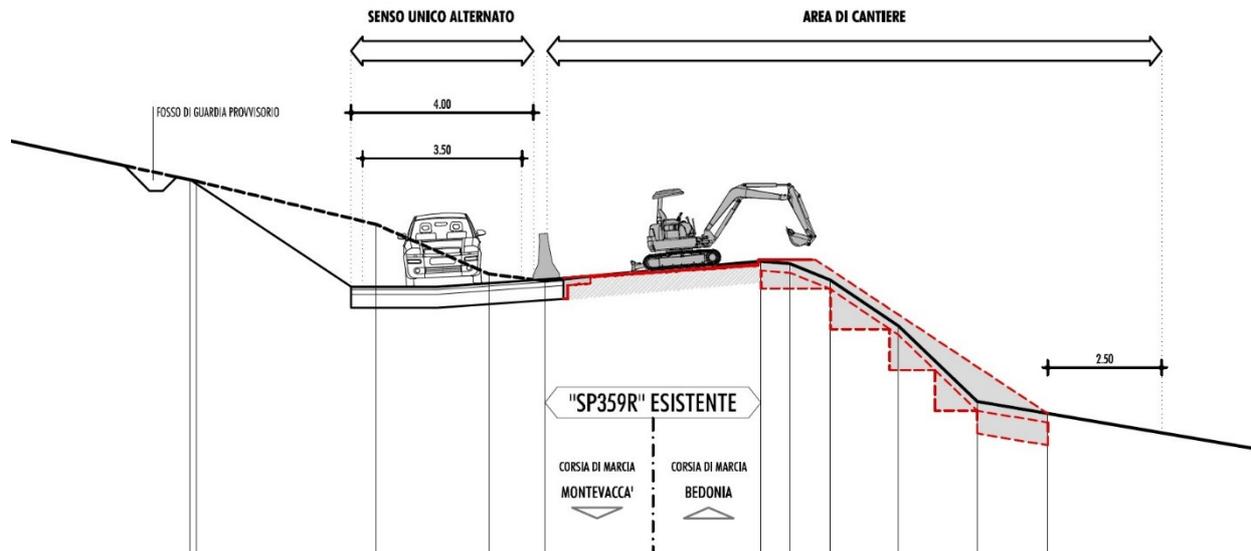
TRATTO 3, FASE 2: TRAFFICO SU CORSIA DI MONTE (ESTRATTO DALL'ELAB. PD.04.04)
